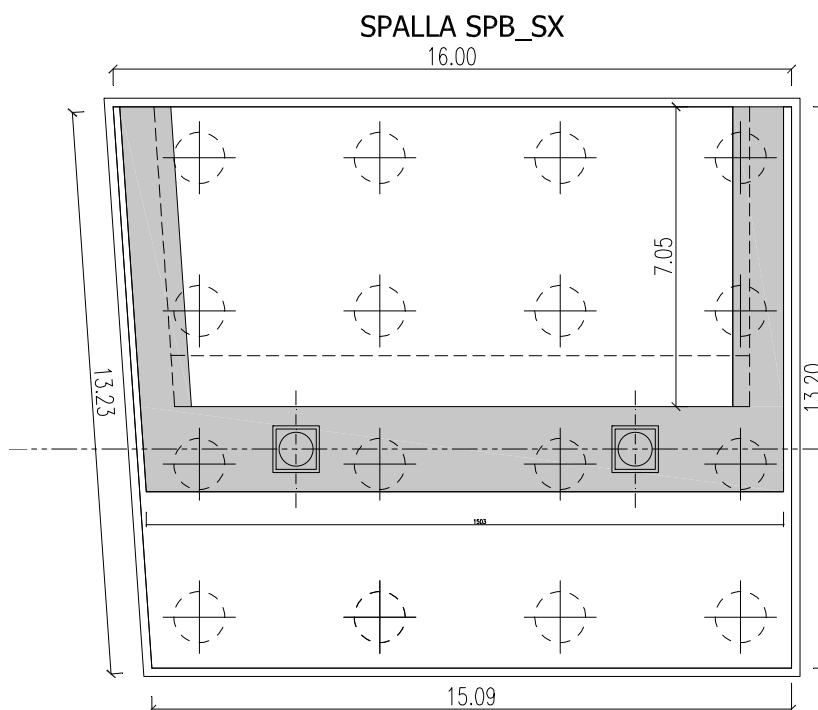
Pianta fondazione Spalla B carreggiata sinistra
